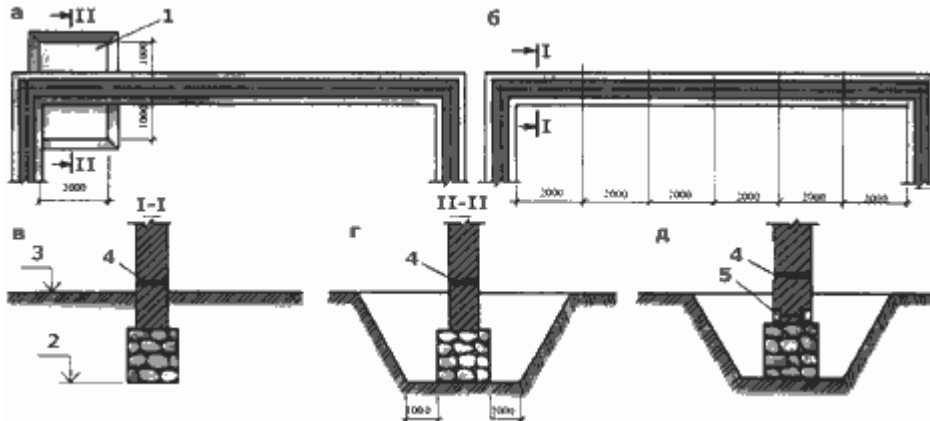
Порядок ремонта ленточных фундаментов: а - разметка участков ремонта ленточного фундамента; б - открытие траншеи; в - ленточный фундамент, подлежащий ремонту; г - ленточный фундамент в отрытой траншее; д - закладка в стены разгрузочных балок.
